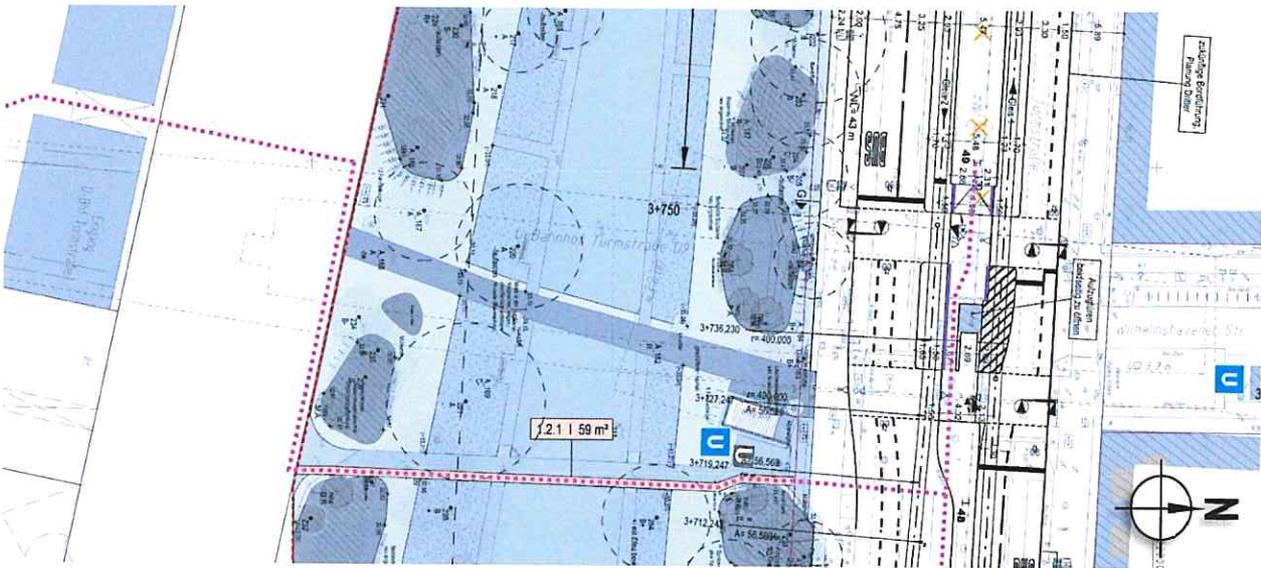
Eingriff Leitungstrasse Kleiner Tiergarten, Lageplan
